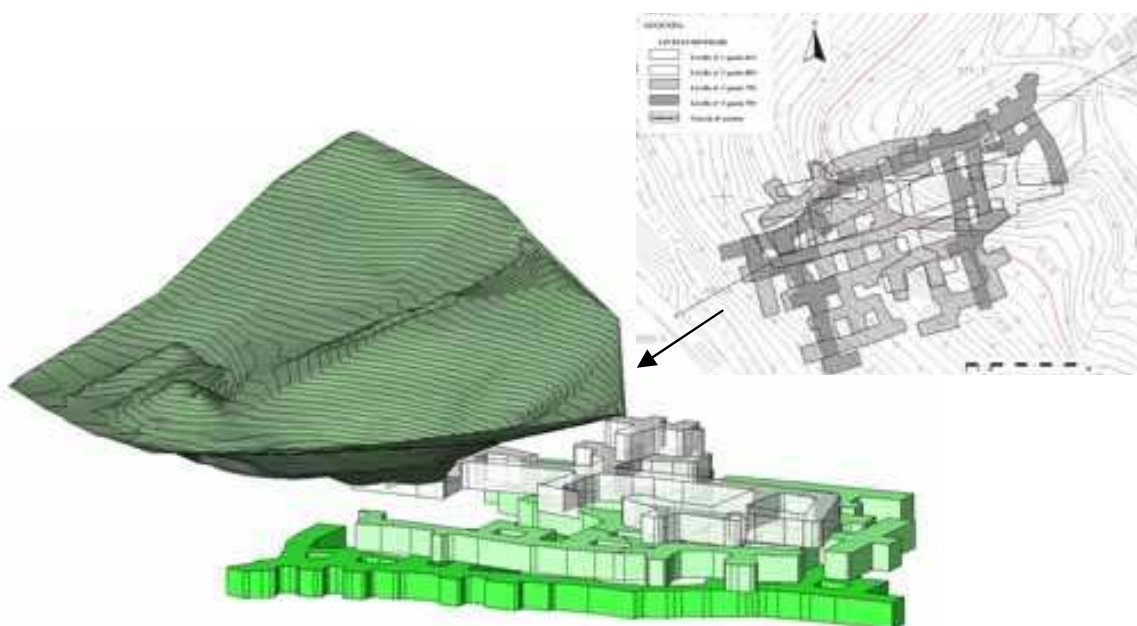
Planimetria e vista prospettica 3D Cava Carale. La vista 3D evidenzia in grigio i livelli 3-4 completamente allagati.
